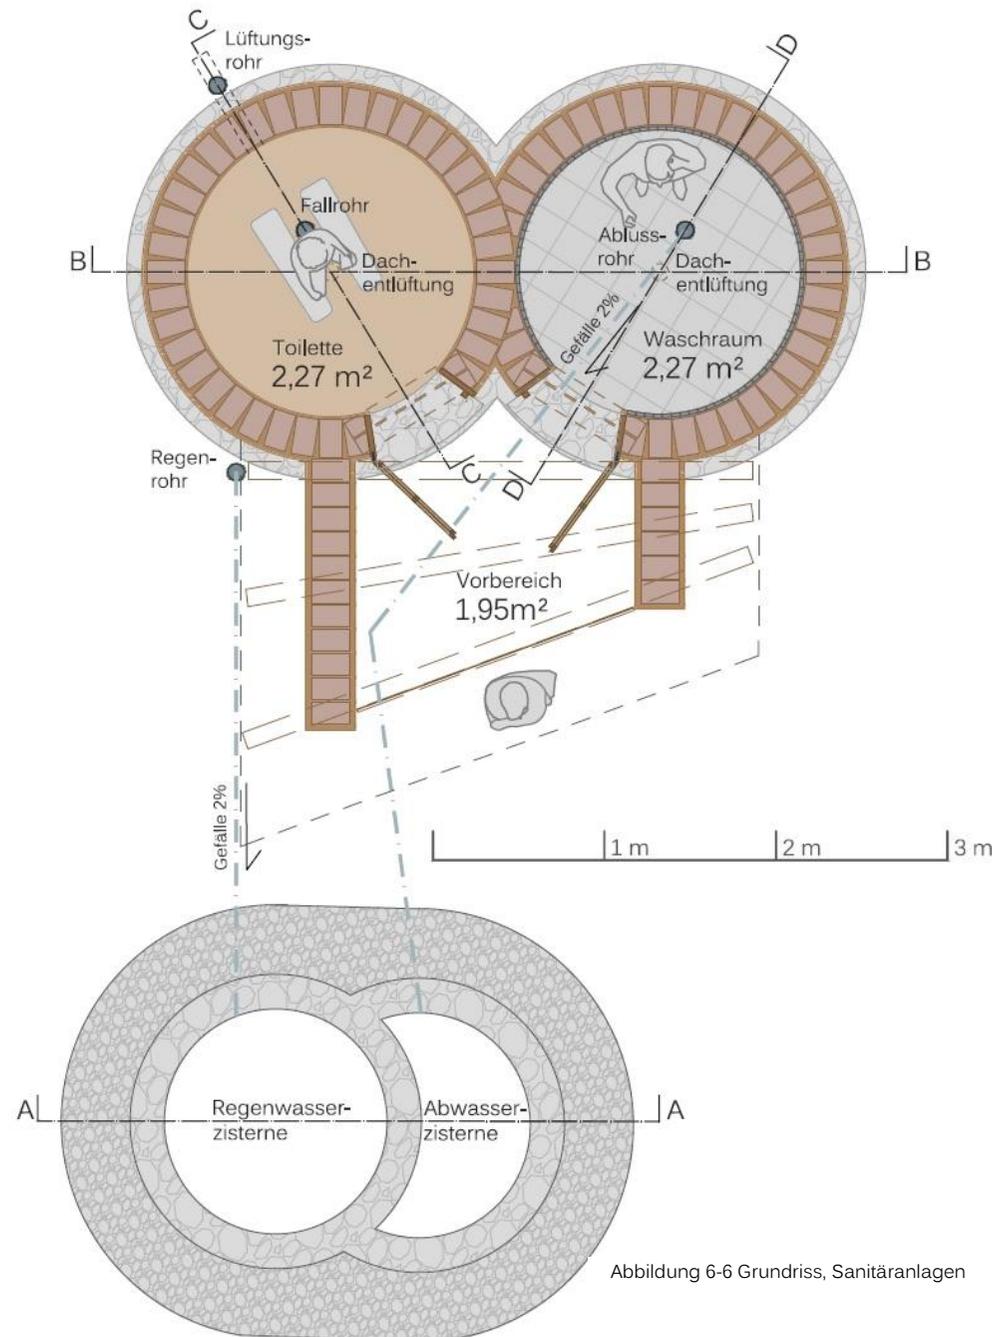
Grundriss, Sanitäreinlagen
